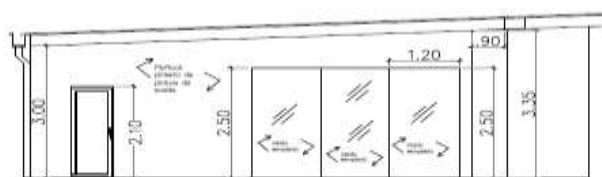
Diseño del proyecto "ECO SPOT" por secciones
